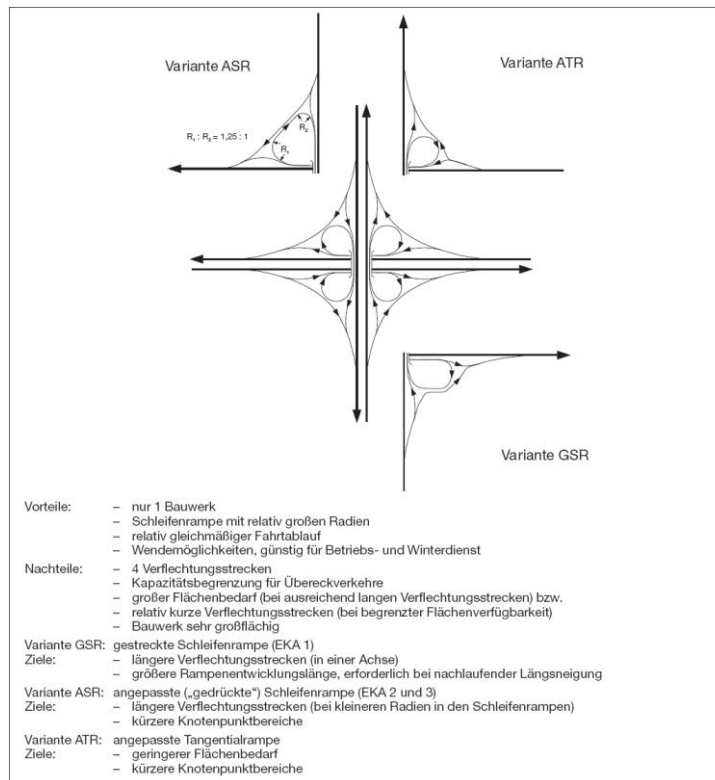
Kleeblatt (Grundform) mit Varianten der Rampenführungen (RAA, 2008)
